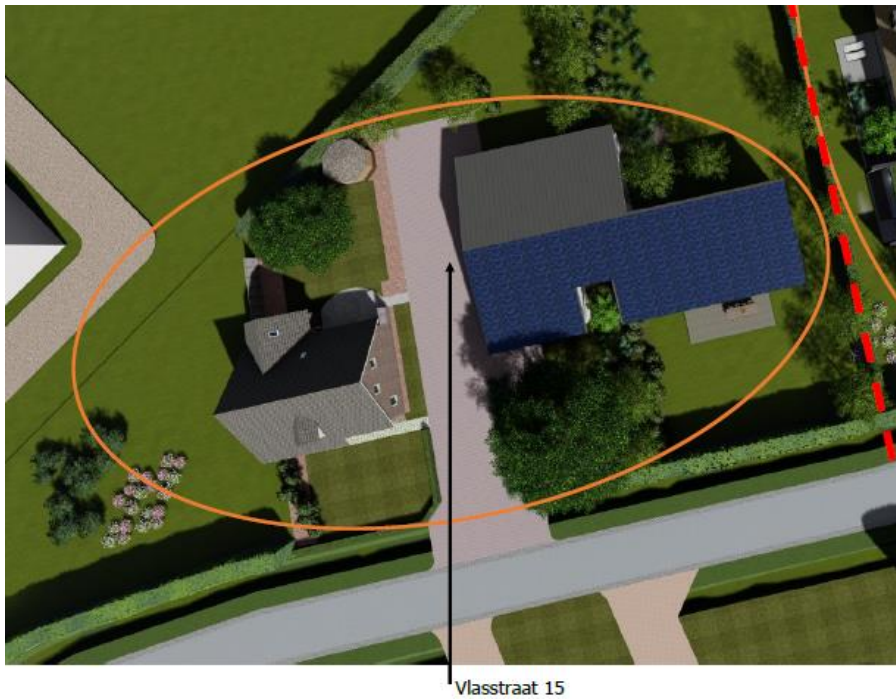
Beoogde bestemmingsplanverbeeding op de planlocatie
